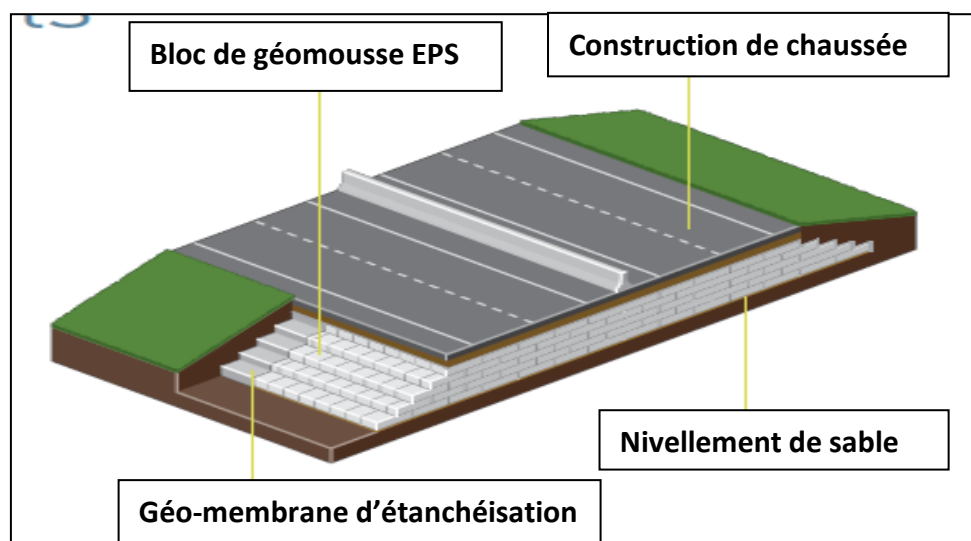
Coupe transversale de la construction de routes à l'aide d'une géo-mousse [82].
